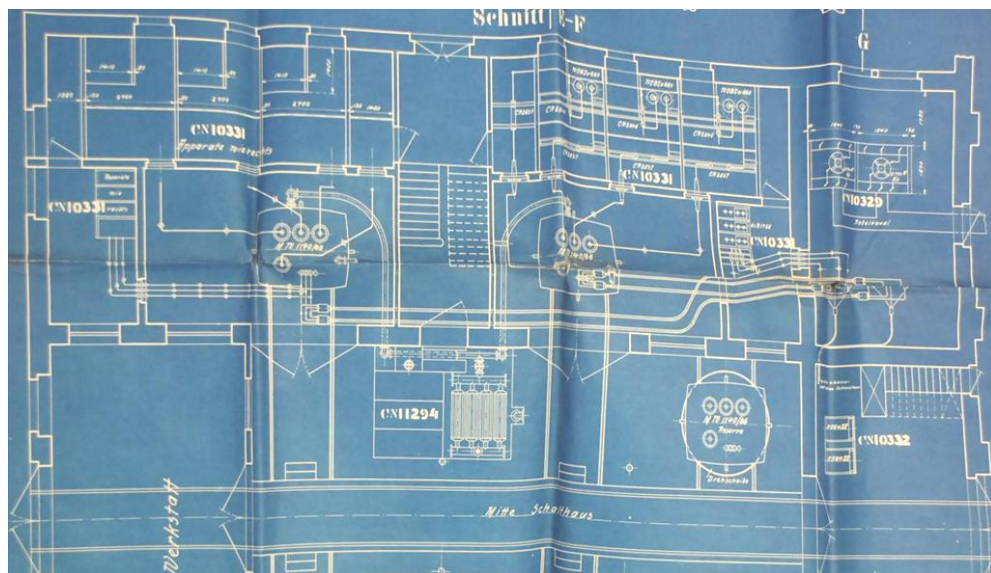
Planta de distribución de Planta Baja del Edificio de Transformadores. Proyecto. Berlín, 16-05-1908. Fuente: AHISA
